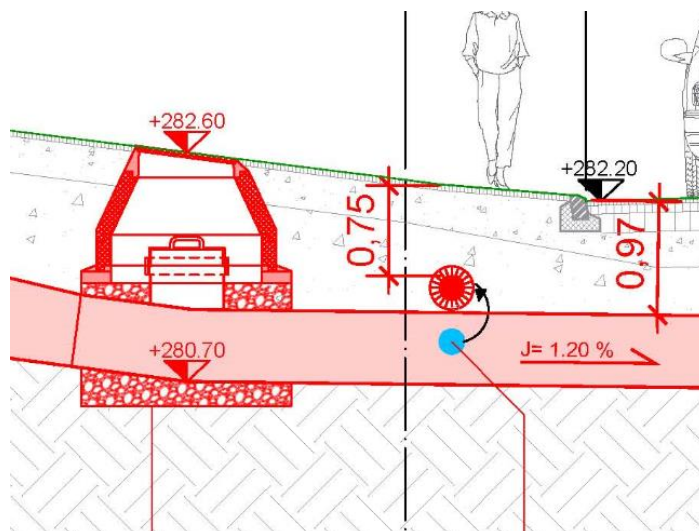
Estratto sezione con condotta comune di Caslano da spostare
